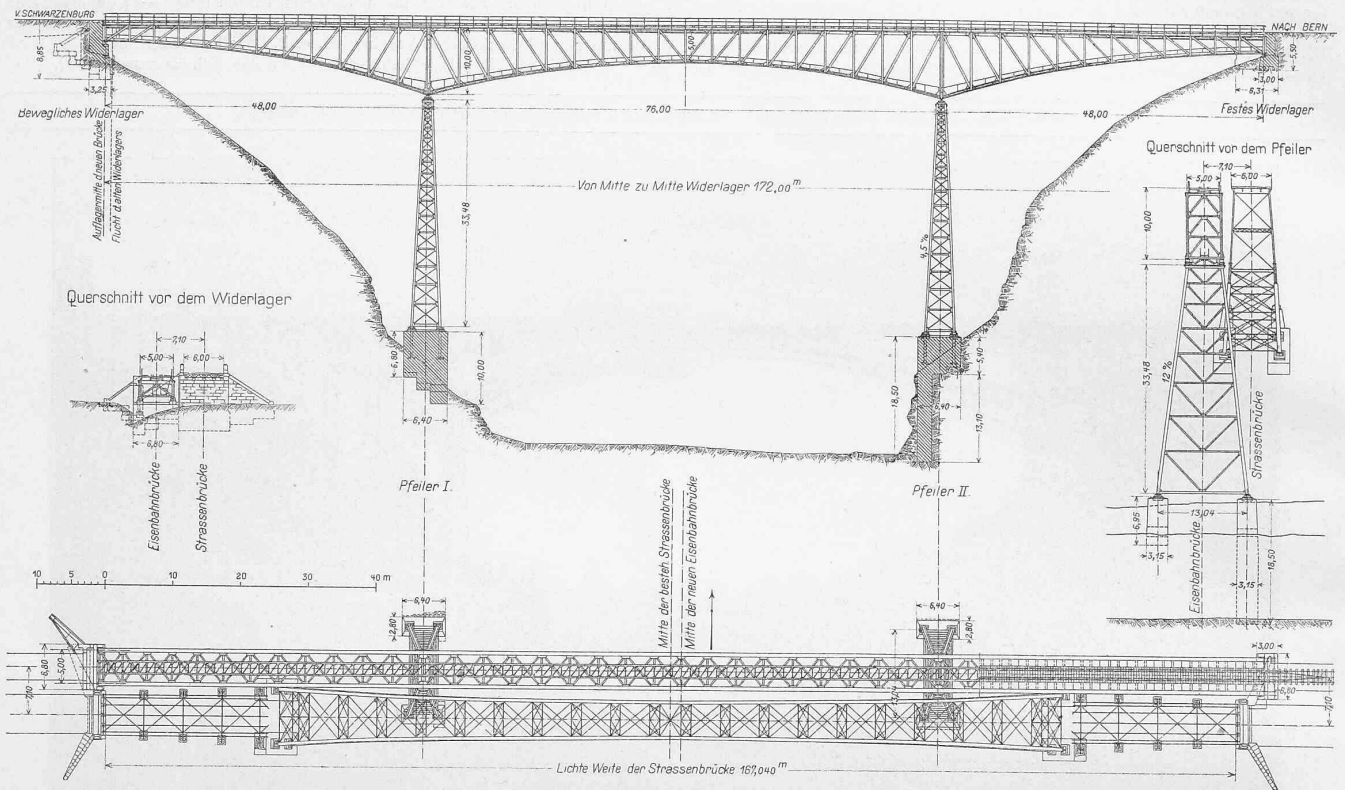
Gesamtansicht, Grundriss und Schnitte der Brücke. — 1 : 1000.
